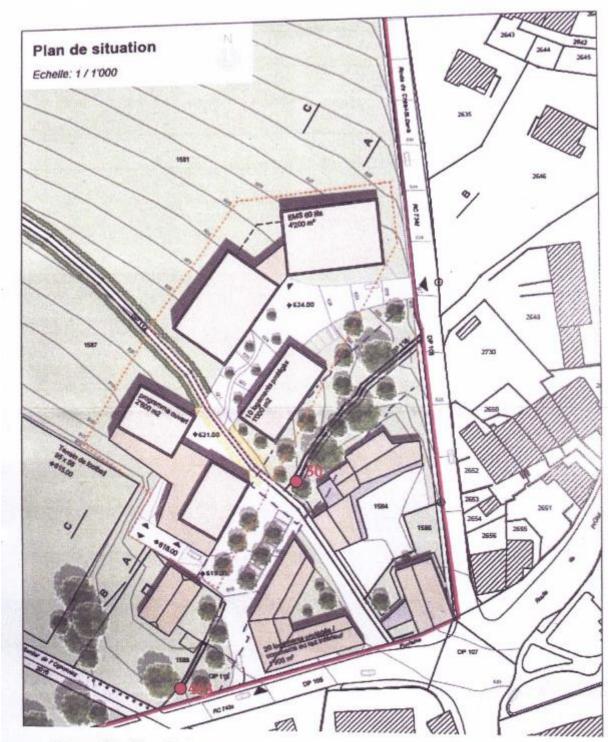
Plan de situation du projet Sud sur les parcelles n°1581 et n°1587
